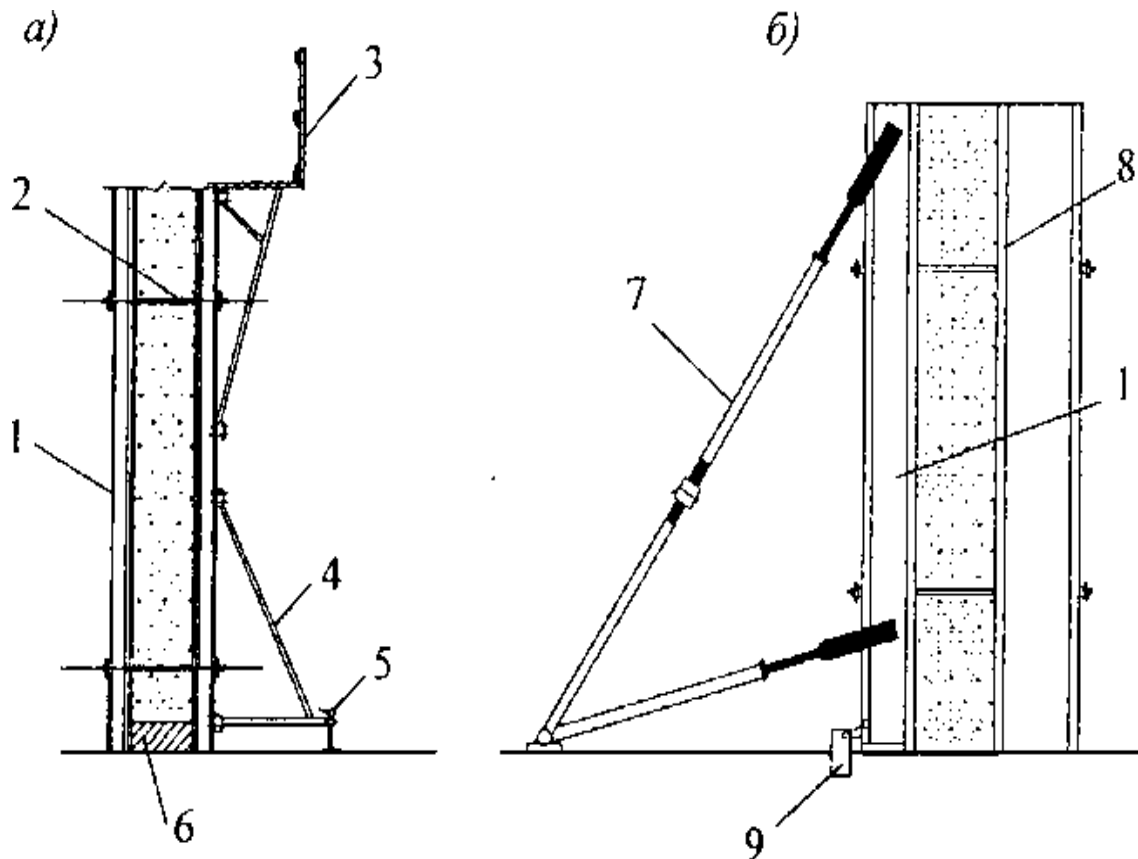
Фрагмент установки великощитової опалубки для бетонування стін
